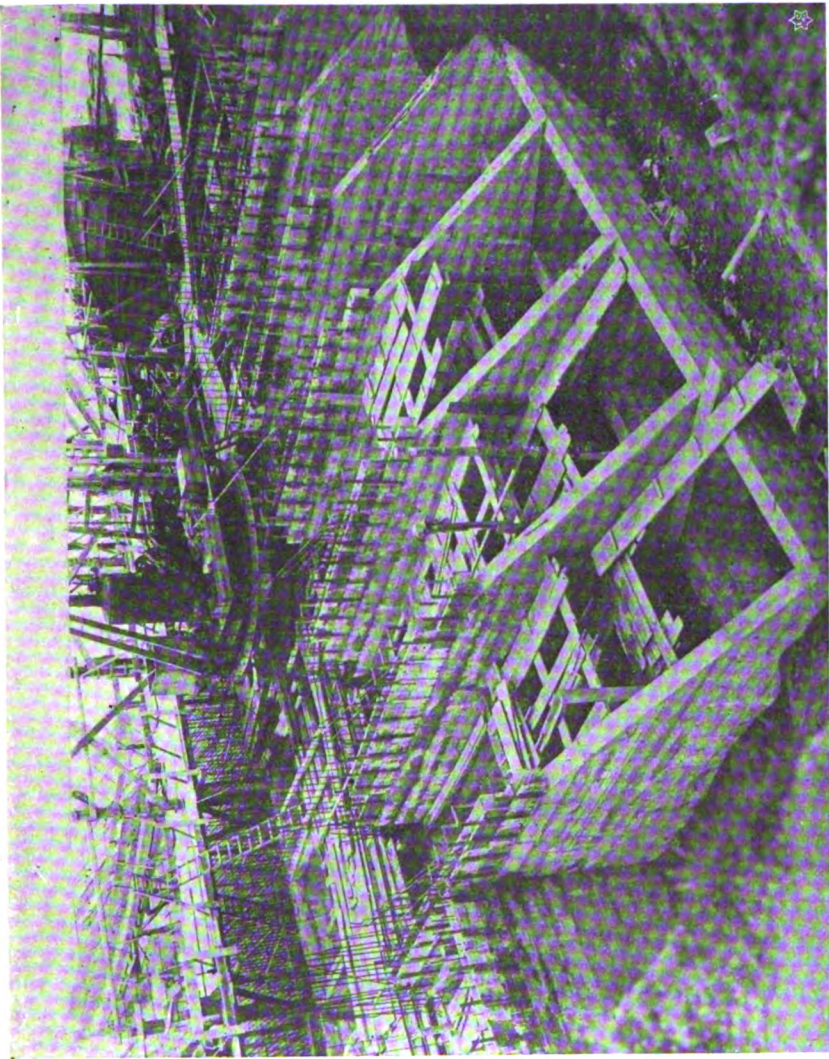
Veduta posteriore della elevazione spalle ancora non interrate.
